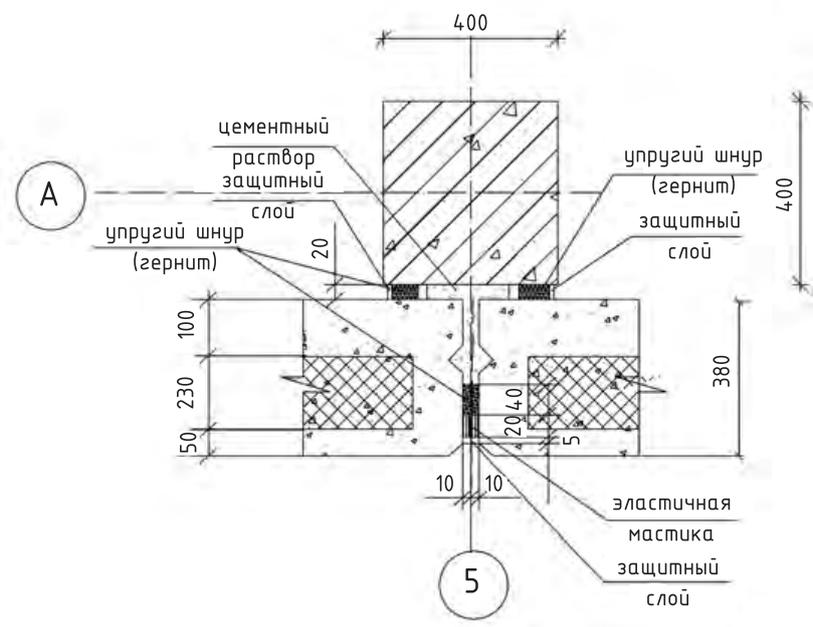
Вертикальный стык колонны с наружными стеновыми панелями
